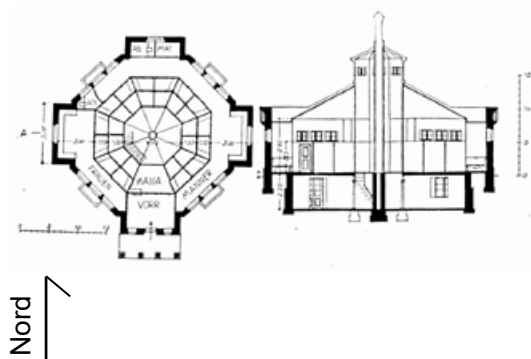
Grundriss und Schnitt (BAI 1912, S. 656).
